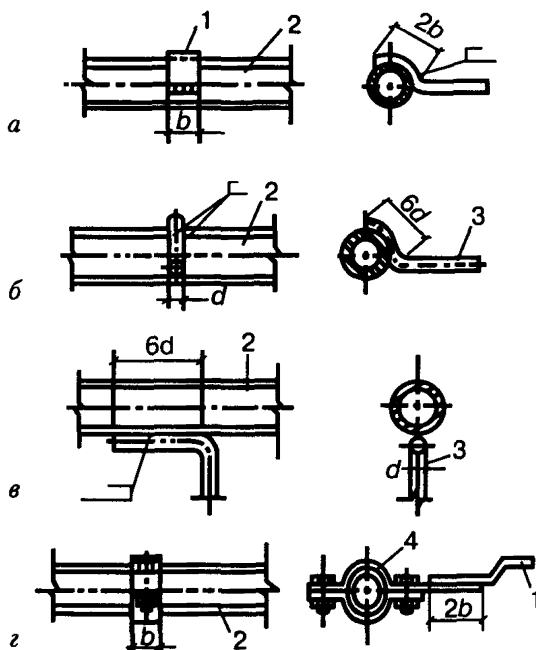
Присоединение заземляющего проводника к трубопроводу сваркой (а – в)
